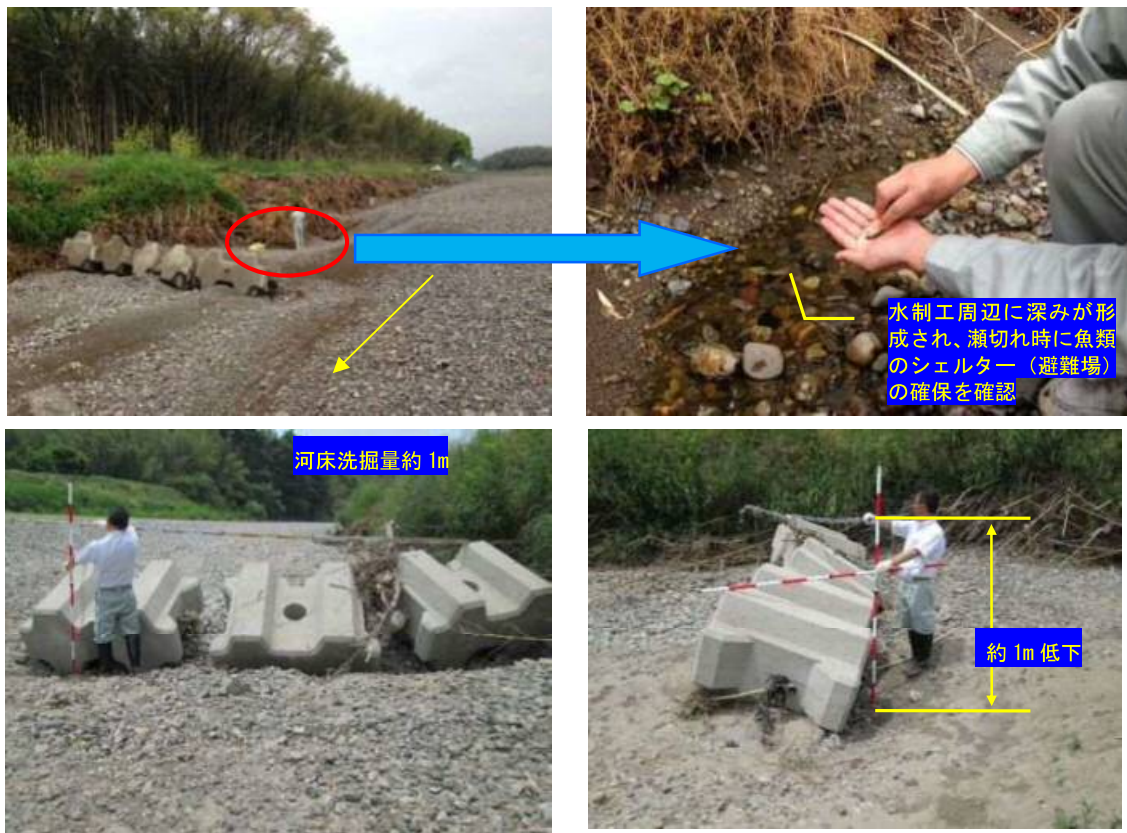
試験施工箇所のモニタリング（施工後約 4 ヶ月後）
